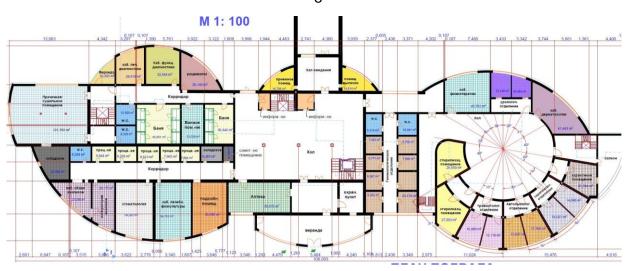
План 1-го этажа первого корпуса РМК «Ангола»
